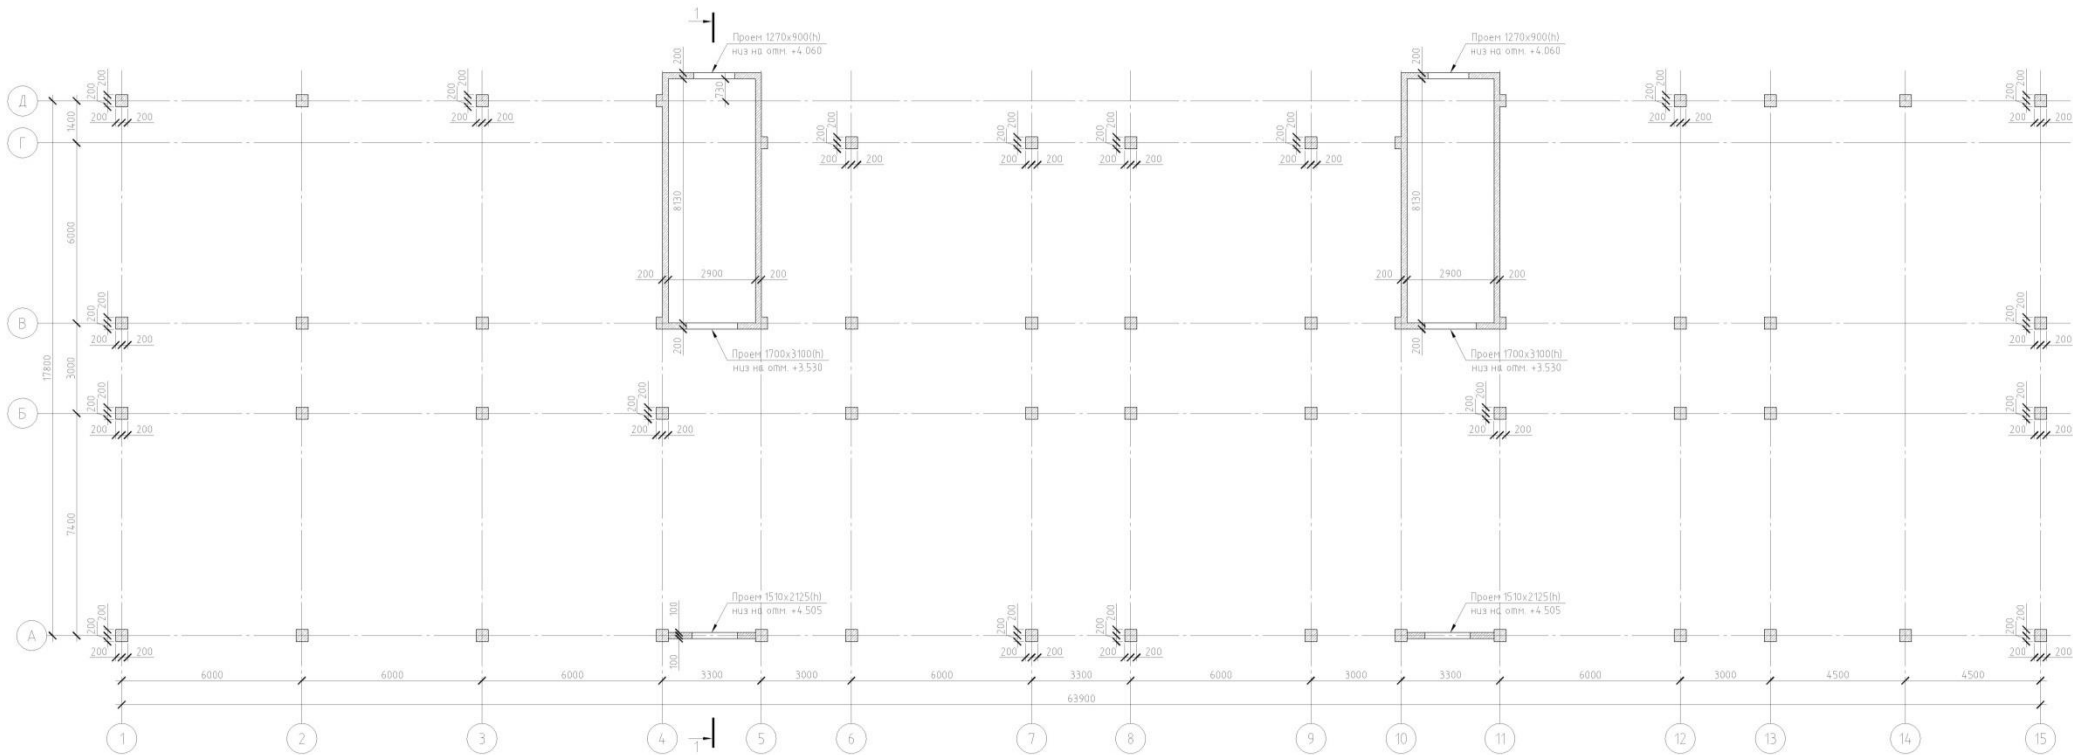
Схема расположения несущих монолитных стен и колонн 2-го этажа с отм. +3,530
